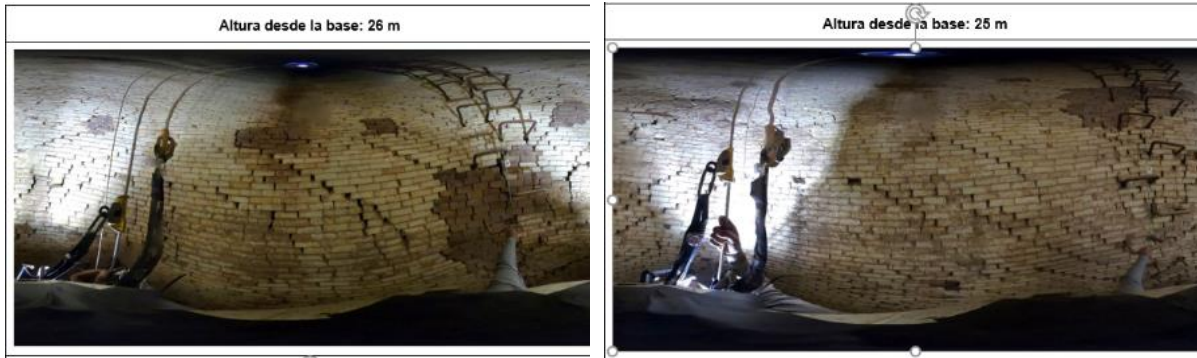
Vista fotografías 360° de la inspección interior tipo.
